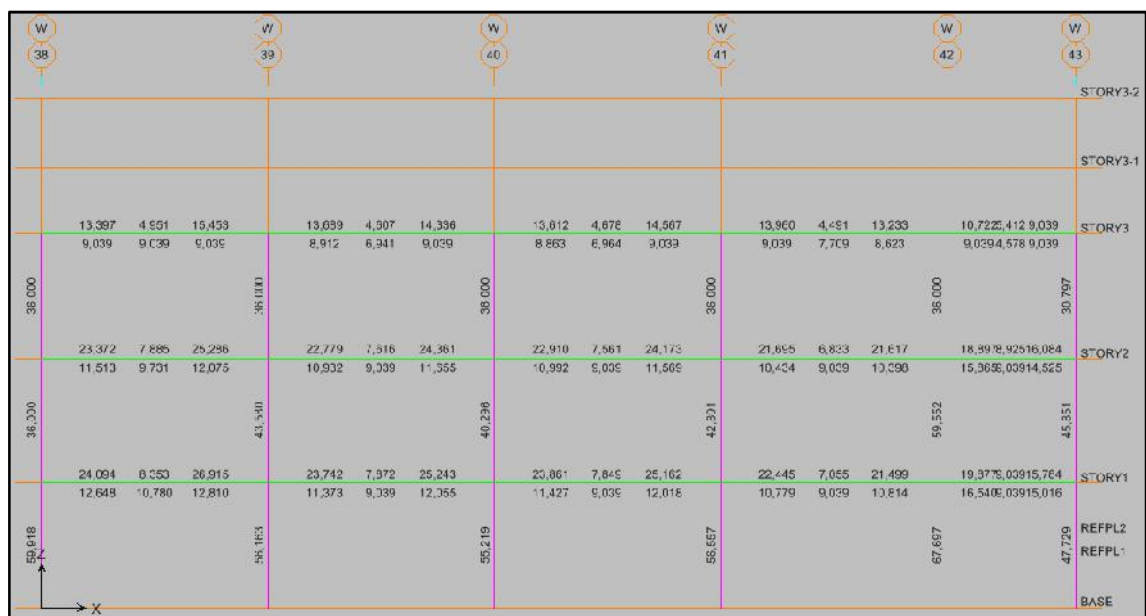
Acero en vigas pórtico W, Consulta Externa II
